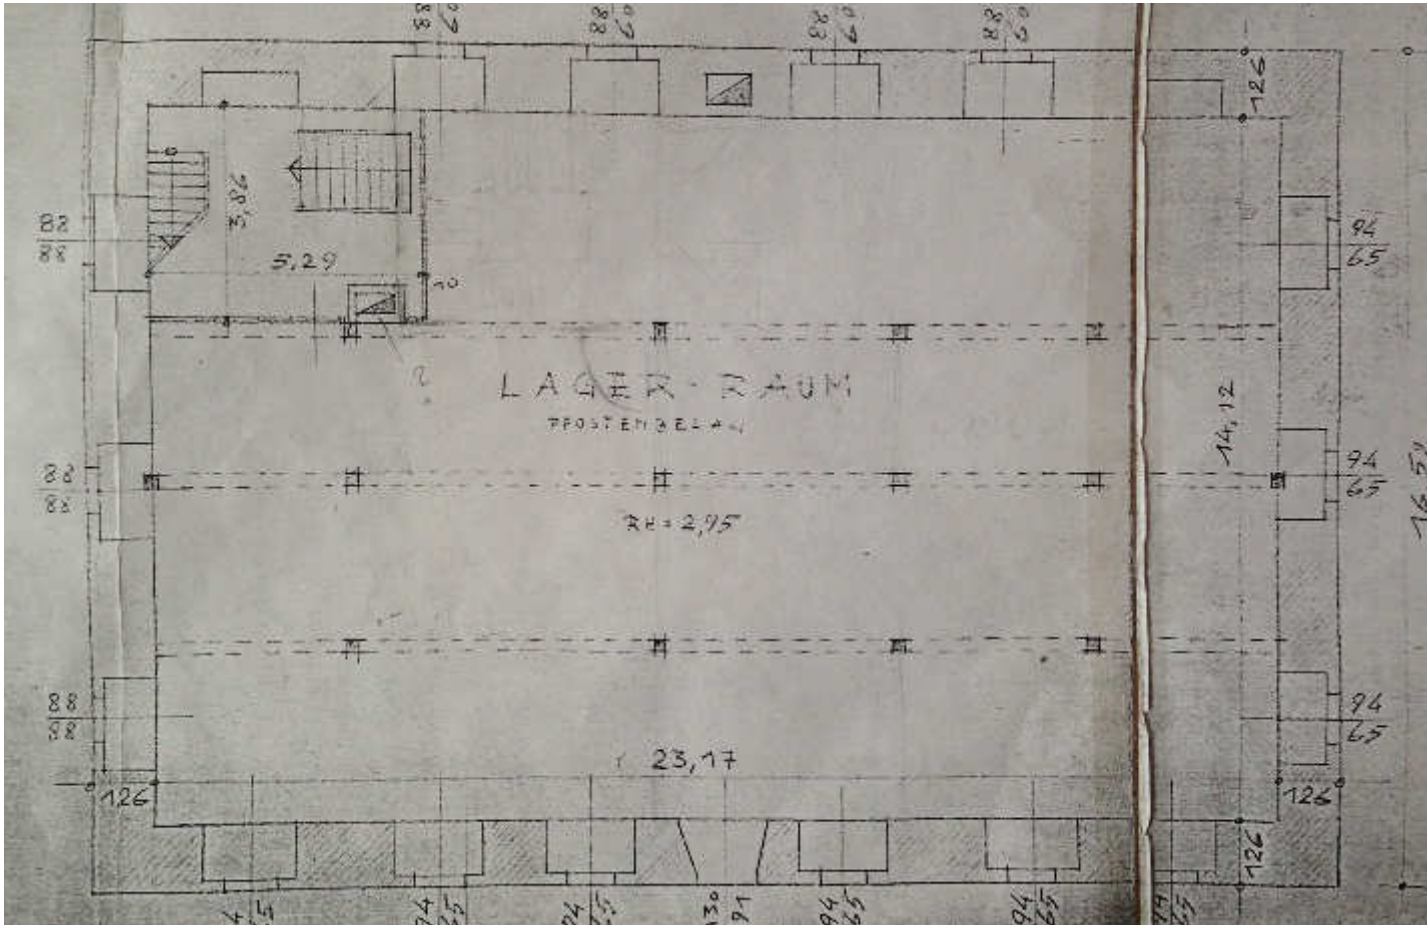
Bestandsplan 1959 - Grundriss drittes Speichergeschoss
